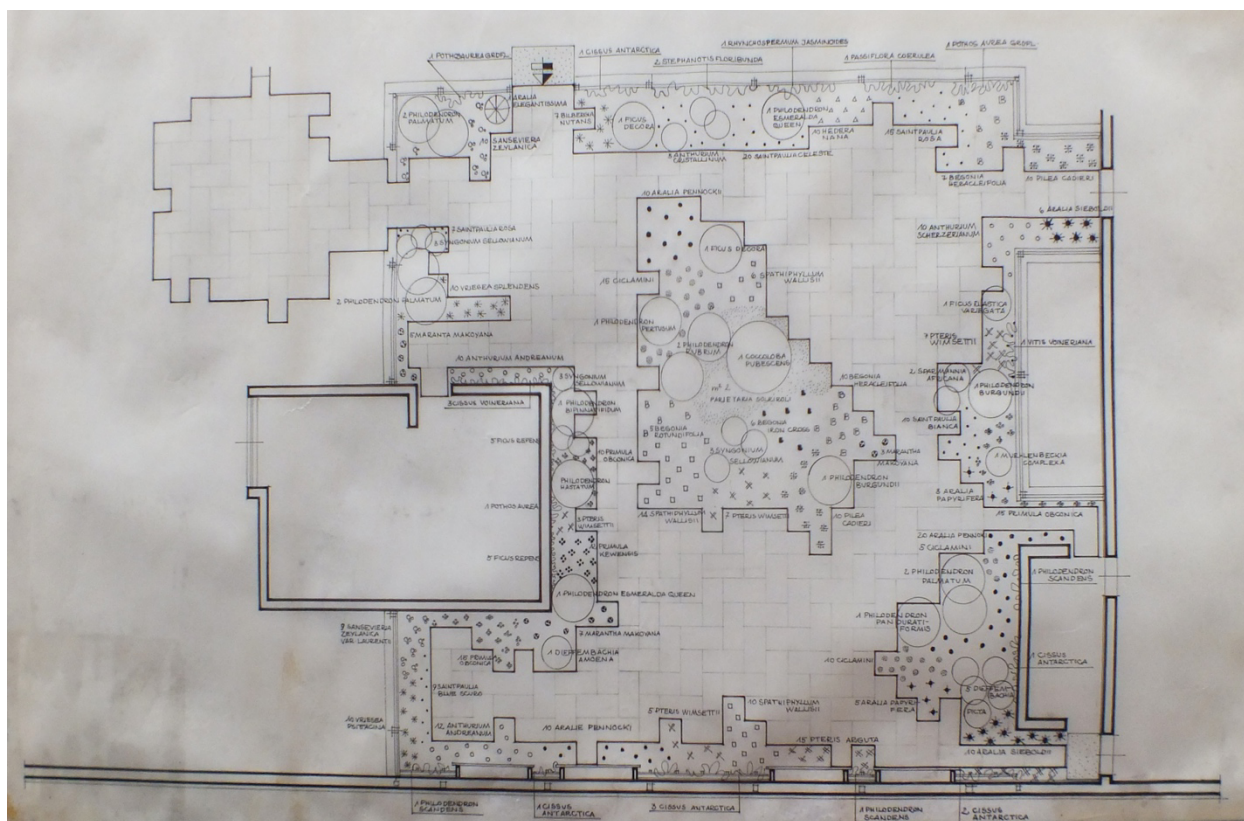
Studio Porcinai, *piantazione serra*, ottobre 1963, disegno 1226/74 ©Archivio Pietro Porcinai, Fiesole. Per gentile concessione. La planimetria evidenzia la ricchezza delle collezioni botaniche – tra piante erbacee, arbusti e rampicanti – selezionati per il giardino d'inverno e la loro attenta disposizione nella configurazione dello spazio del 'padiglione ospiti'.
